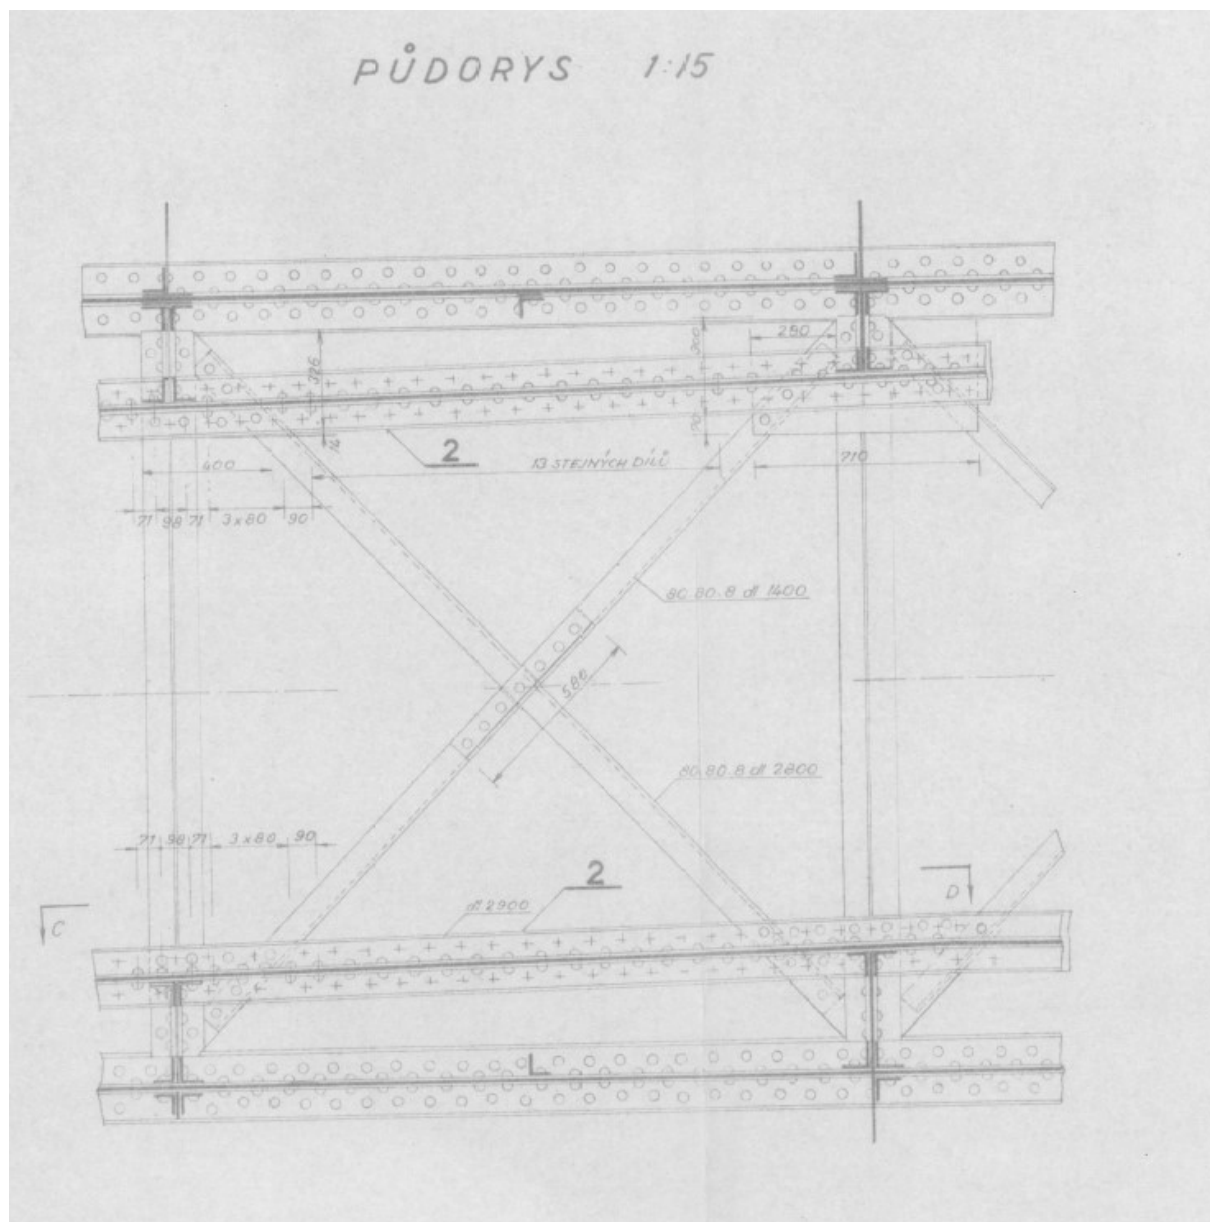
Schématický půdorys (rok 1901) část 1 [2-1]
